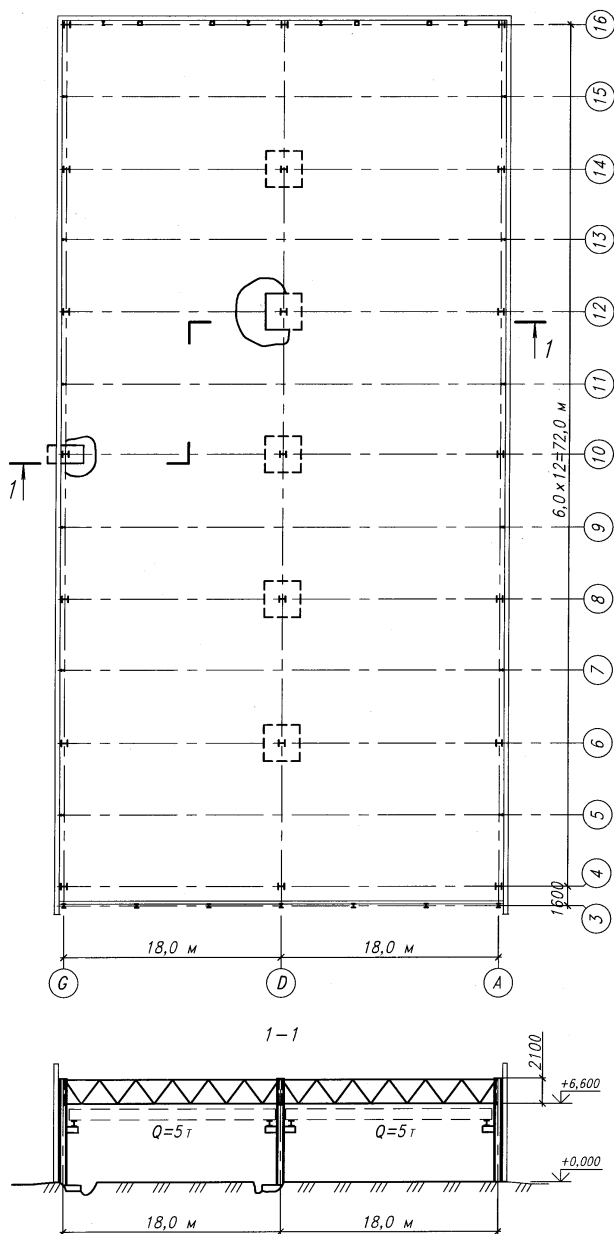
План и поперечный разрез здания. Схема расположения открытых и усиленных фундаментов
